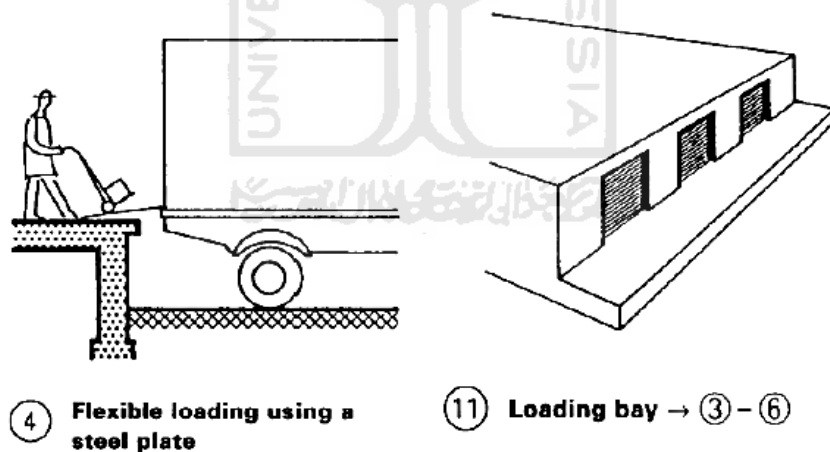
Standar Pola Ruang dan Sirkulasi Parkir
